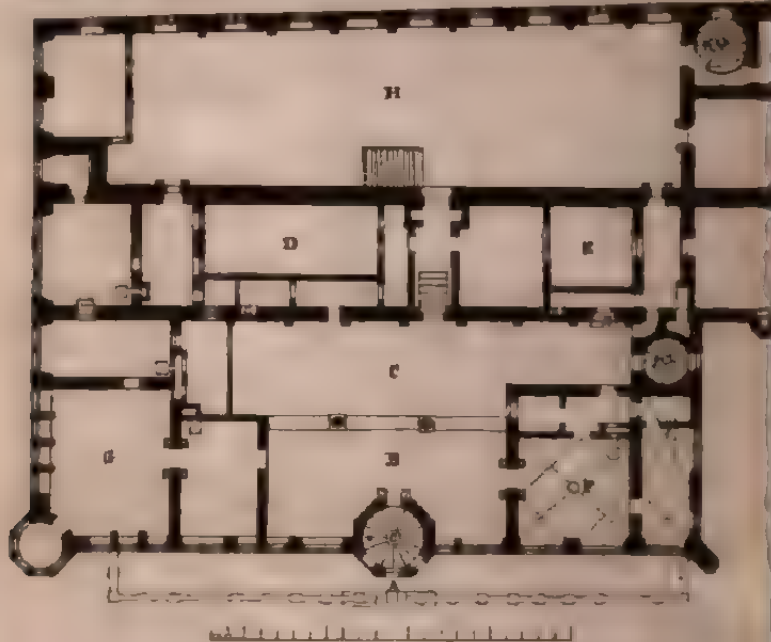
Rathaus zu Rothenberg Grundriss.
